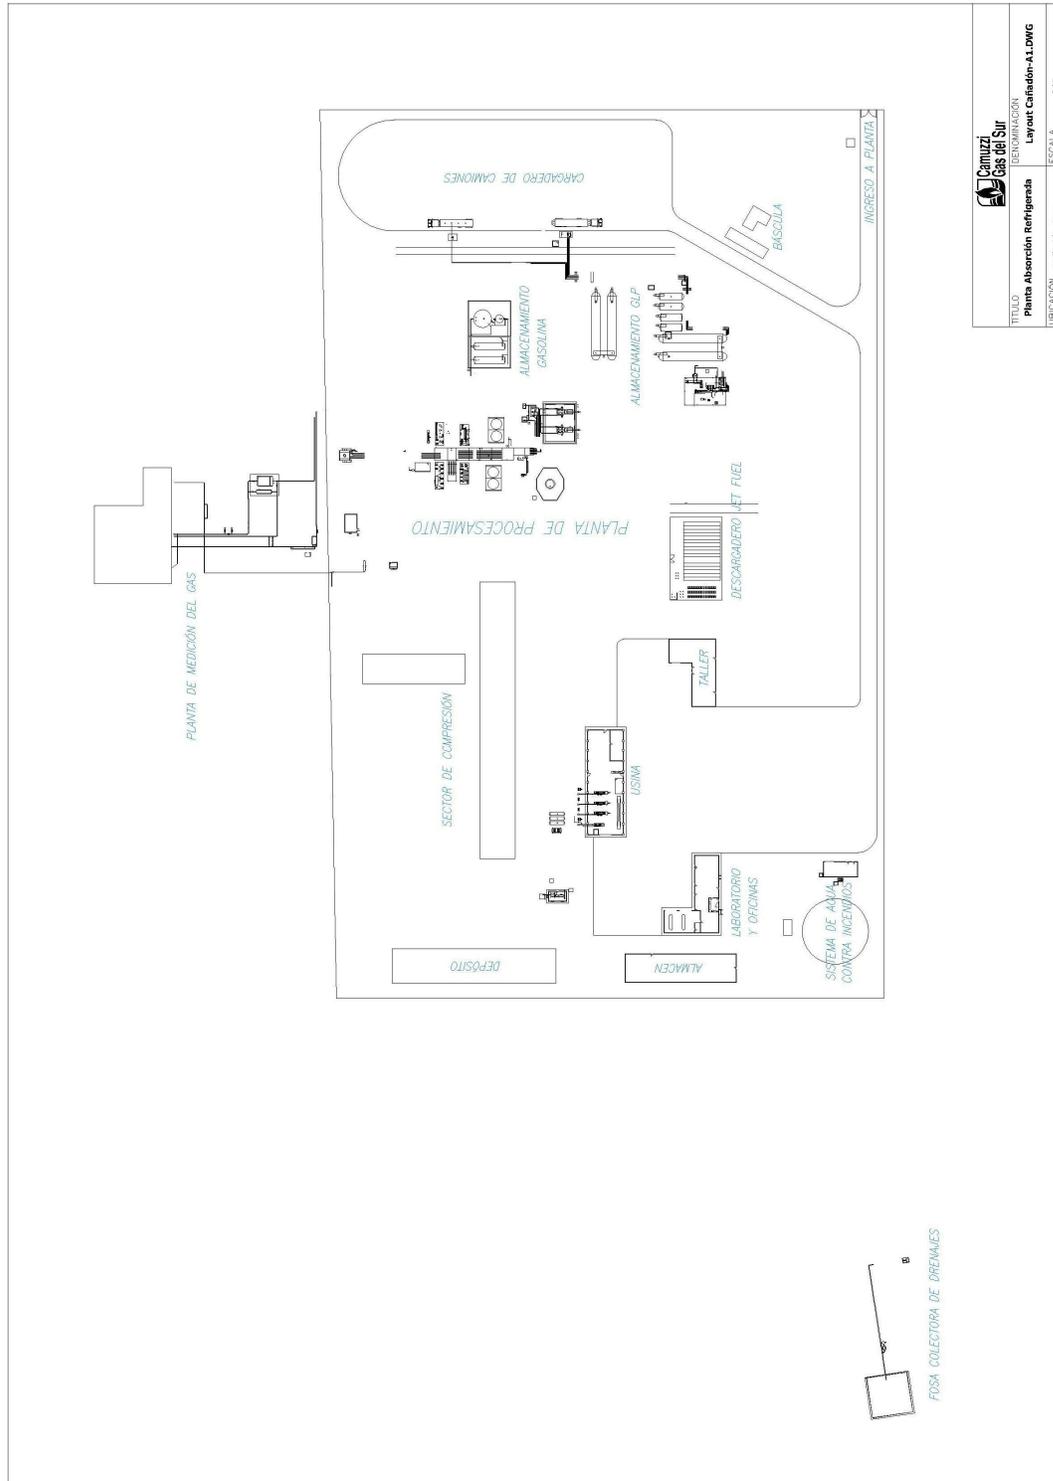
Layout de la planta de Cañadón Seco, con la alternativa 1.
